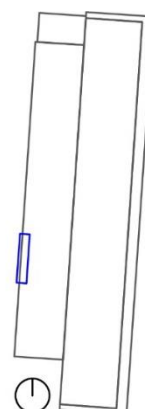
Individuazione del macroelemento in prospetto 1e pianta
